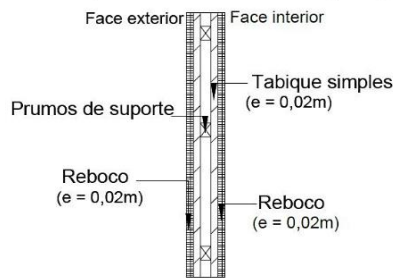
Esquema da solução original construtiva da parede interior PI01.
